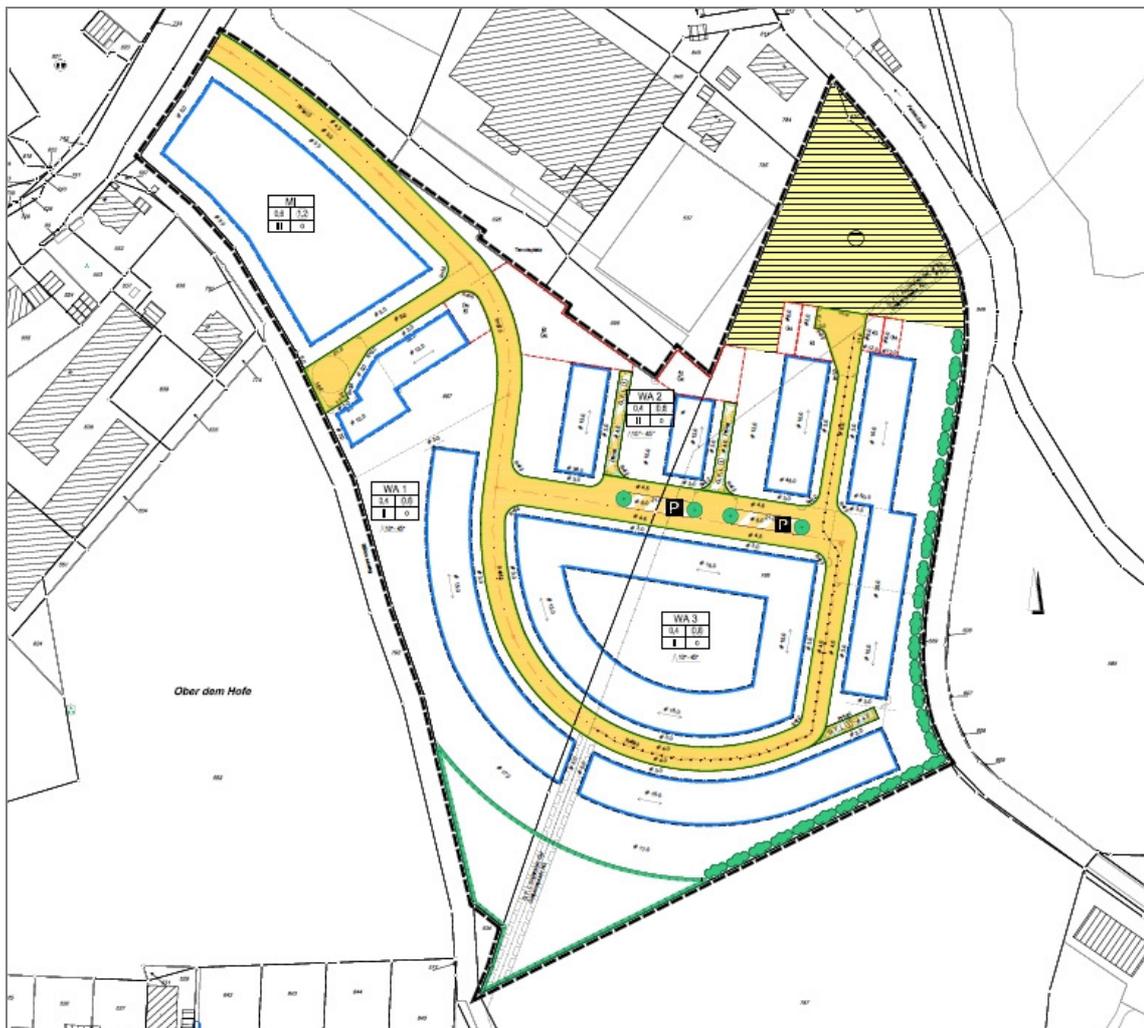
B-Planentwurf (STADT VELBERT, Planausschnitt - Stand März 2016)
